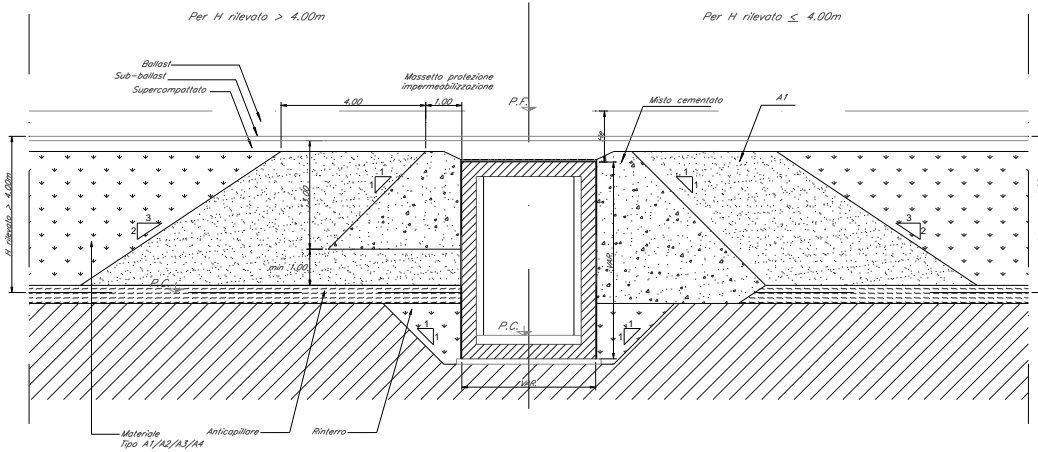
Zona di transizione rilevato-scatolare con  $1,35 < H_e \leq 1,55$  m
